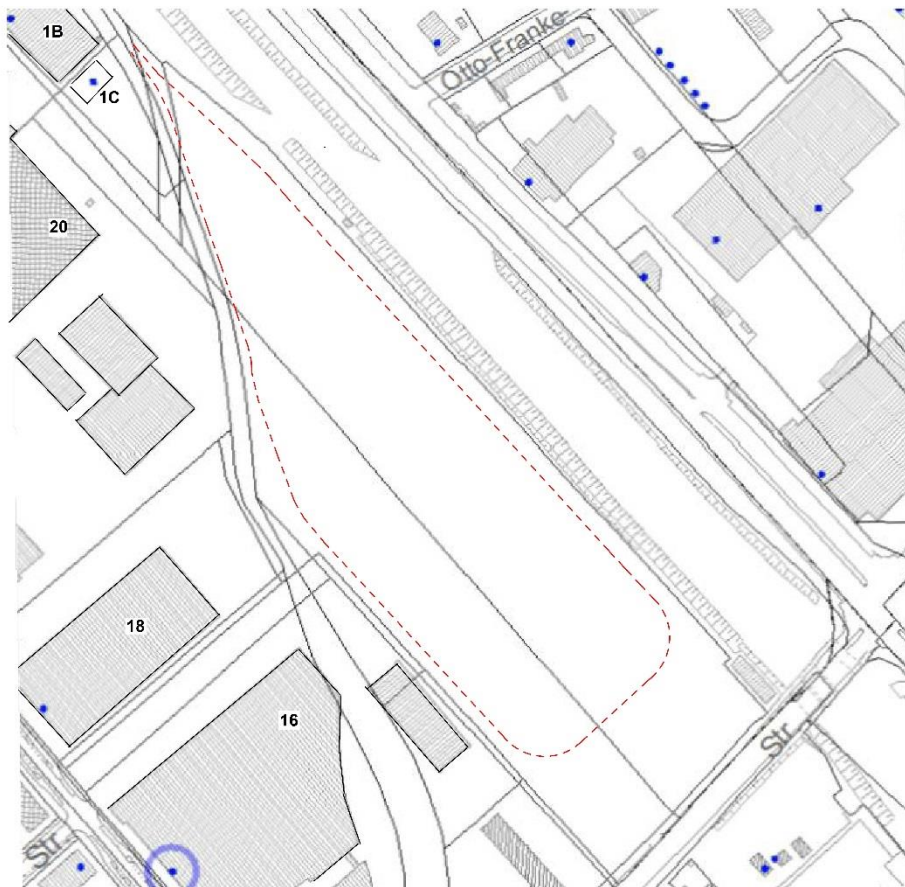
Lageplan (Geoportal-Berlin, U(8))
